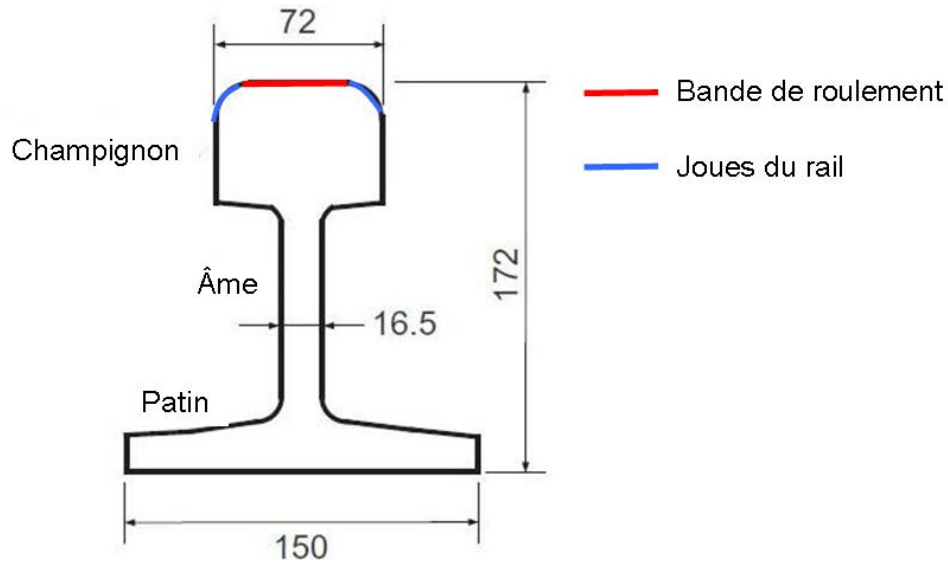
Schéma d'un profil d'un rail 60E1 (Plan exact Norme 13674-1 p61)
